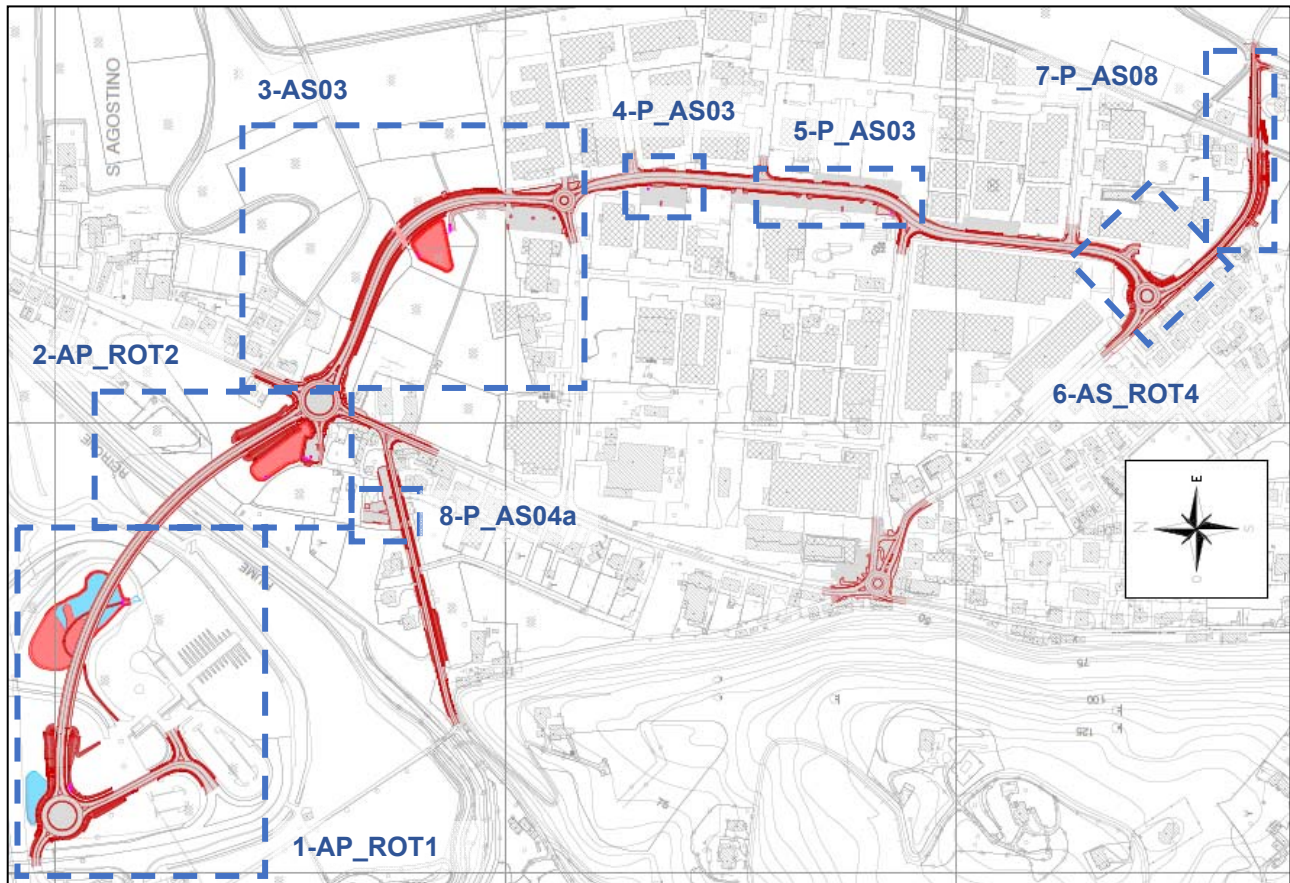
Individuazione dei bacini idraulici della rete di drenaggio della viabilità di progetto
